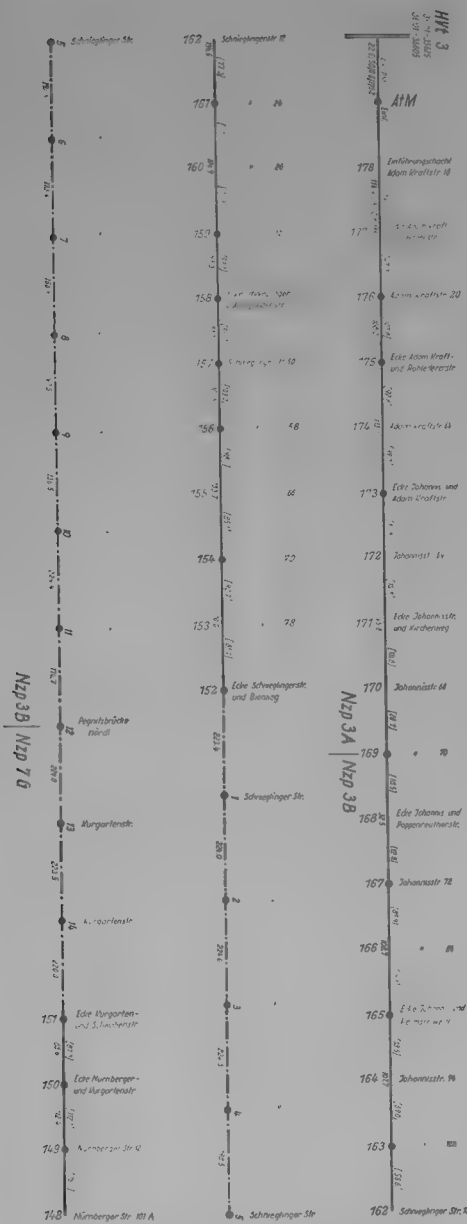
Ausschnitt aus einem Kabelnagenplan.
